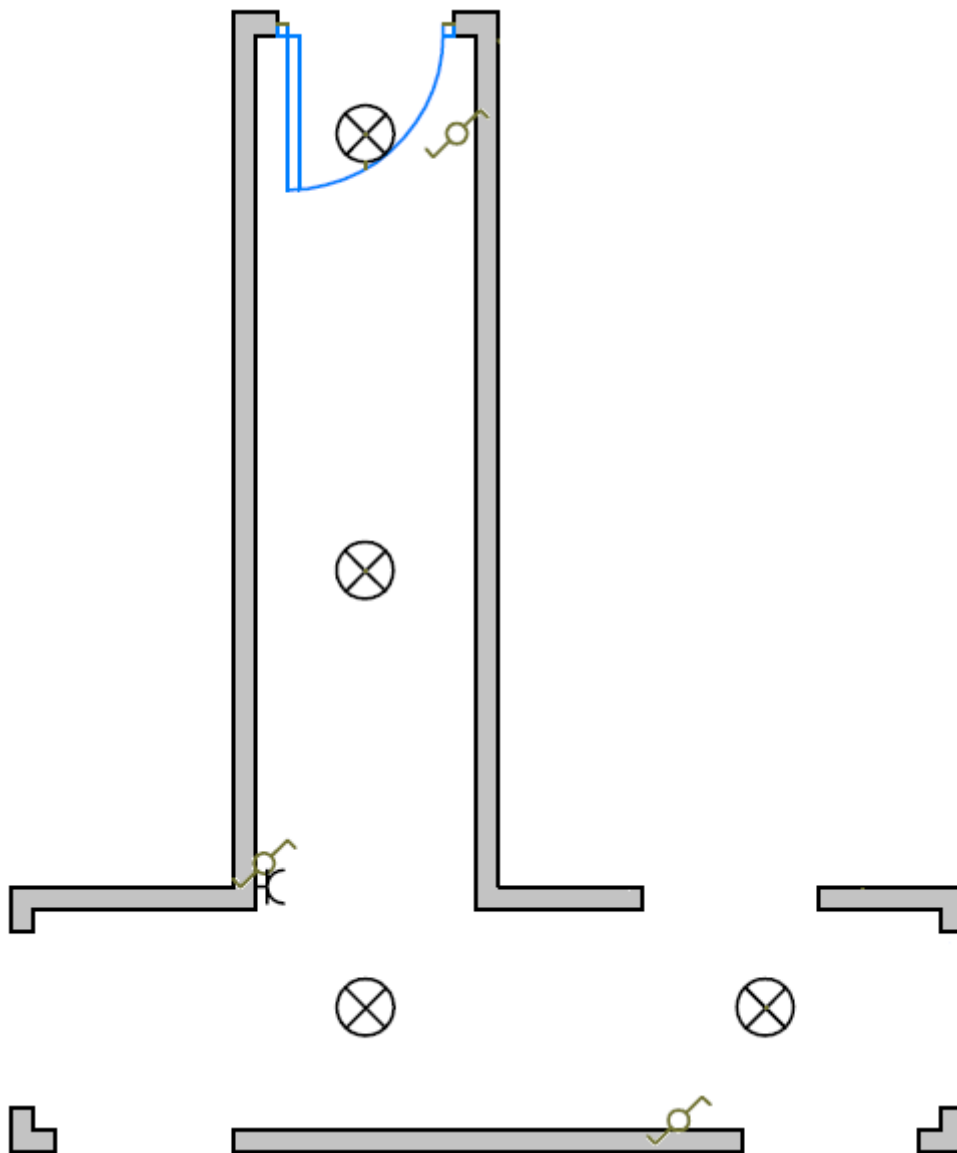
Plano de planta del pasillo. Fuente: Elaboración propia
